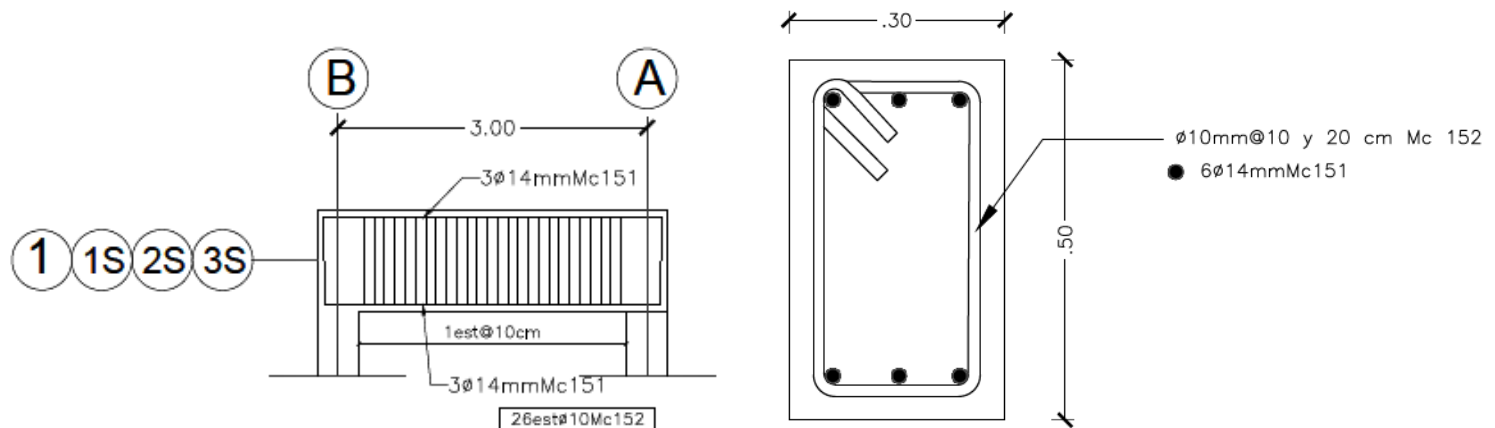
Detalle viga 30 cm x 50 cm, armado de 6 ϕ 14
